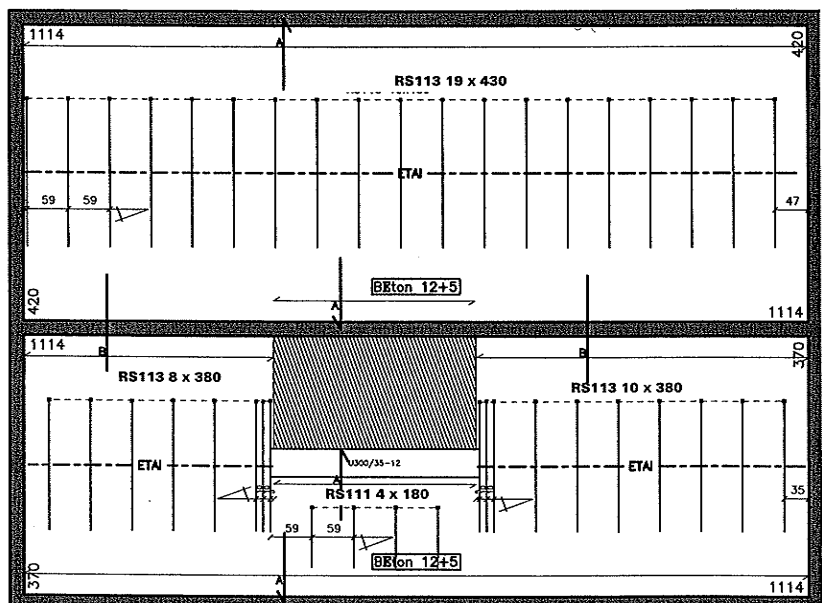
Plan de pose des poutrelles et armatures complémentaires (chapeaux et renforts).
